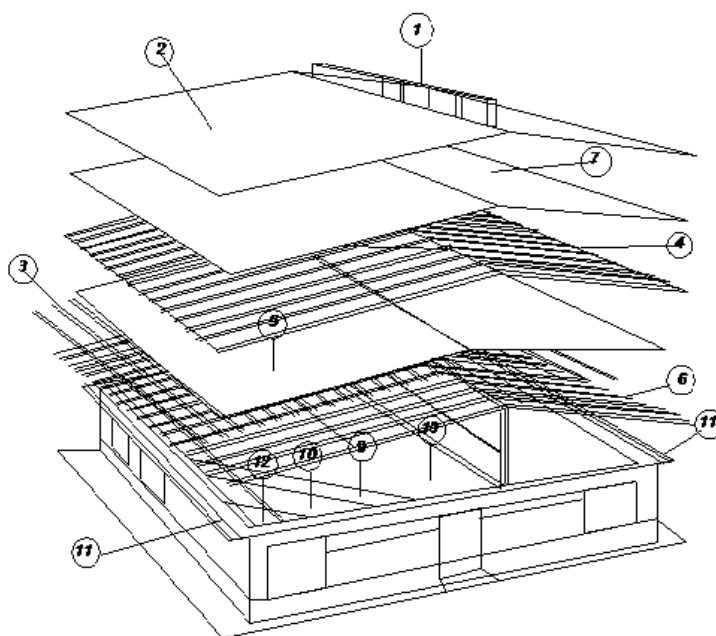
Устройство утепленной кровли с двойной системой вентиляции:
